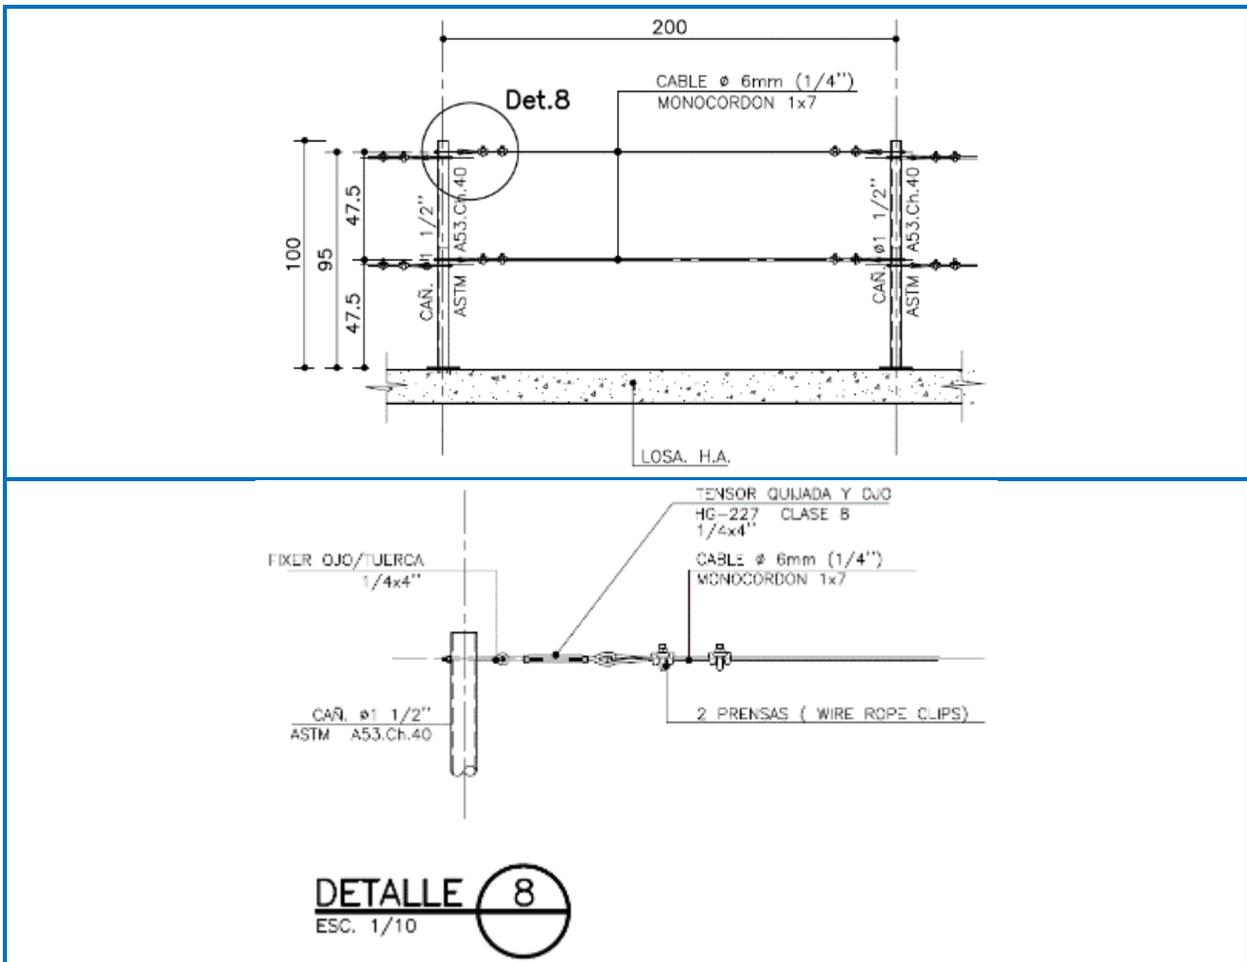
Sistema de protección conectable delimitado por perfiles metálicos verticales (medidas en cm)- Elaboración Propia
